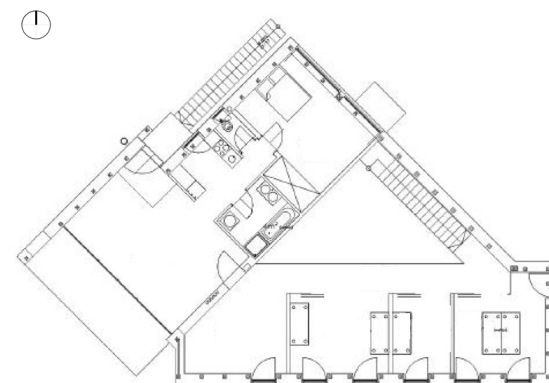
Pianta piano primo; Fonte: A. Themessl, 2004;
